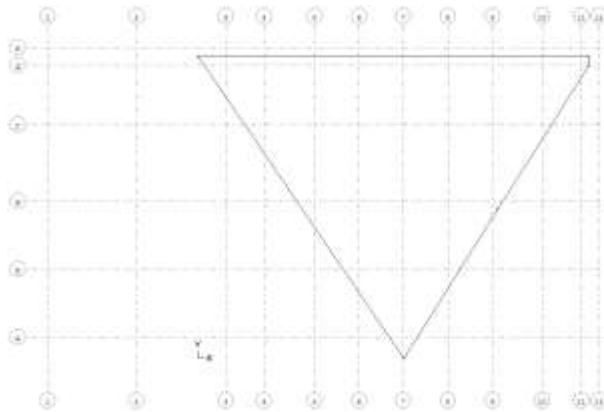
Опалубкове креслення фундаментної плити ФМ-2
